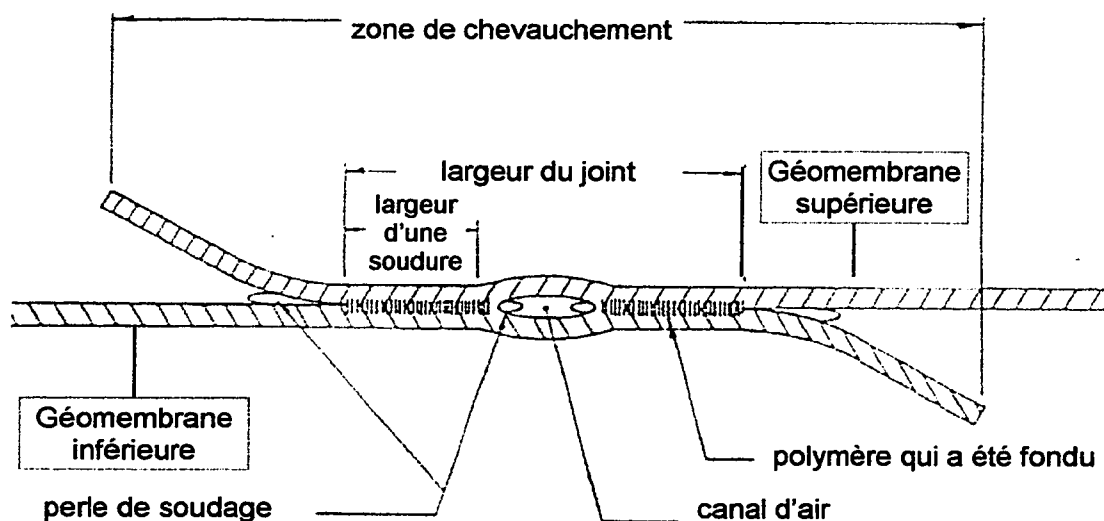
Section en coupe d'une double soudure par fusion
